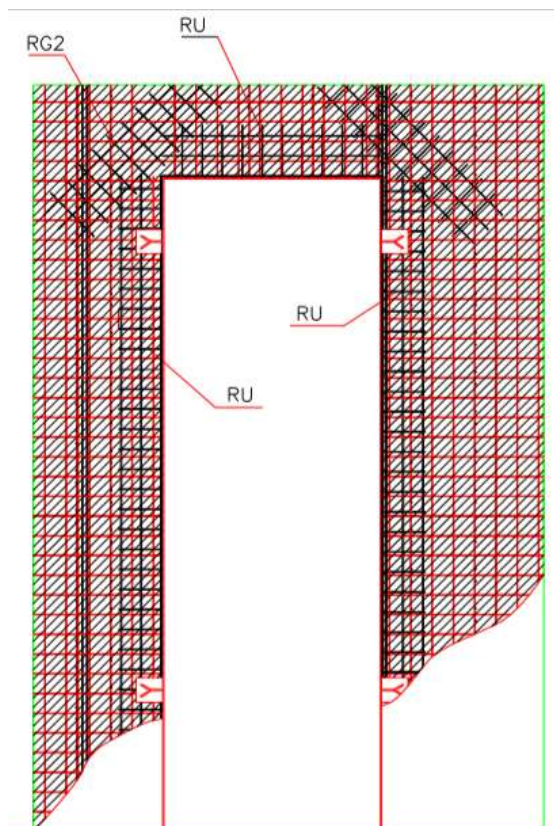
Colocación de malle tipo RG2 y RU, vista frontal - Emmedue, 2008.
